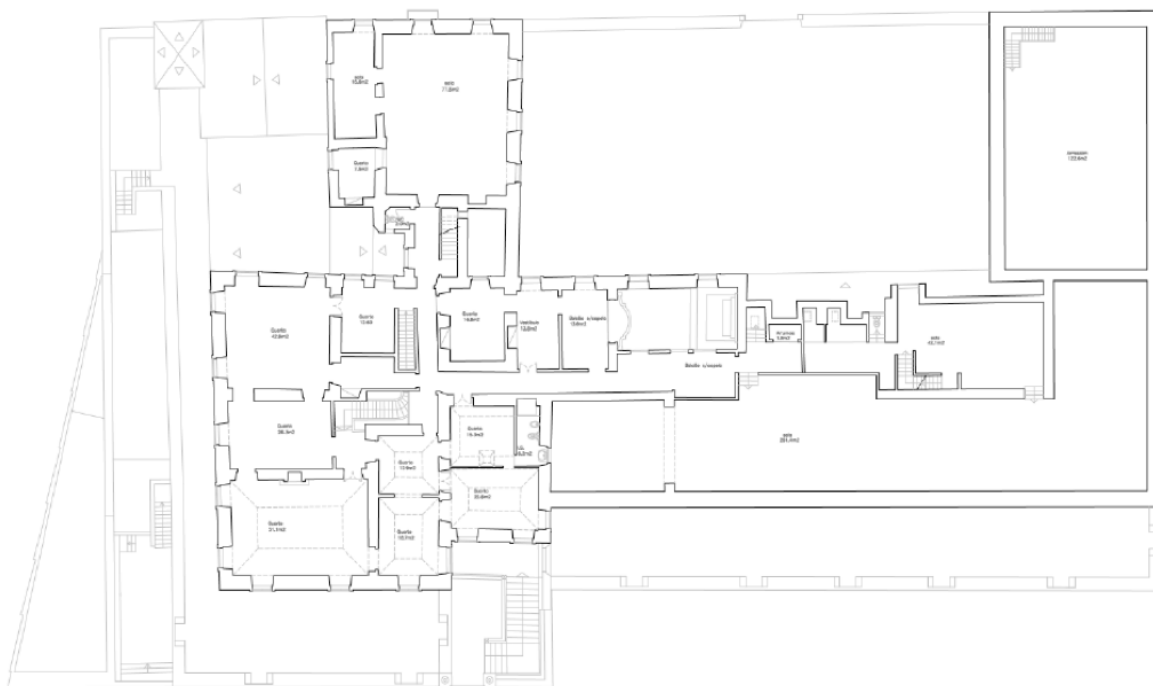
Planta original do piso térreo da Casa do Governador, sem escala
